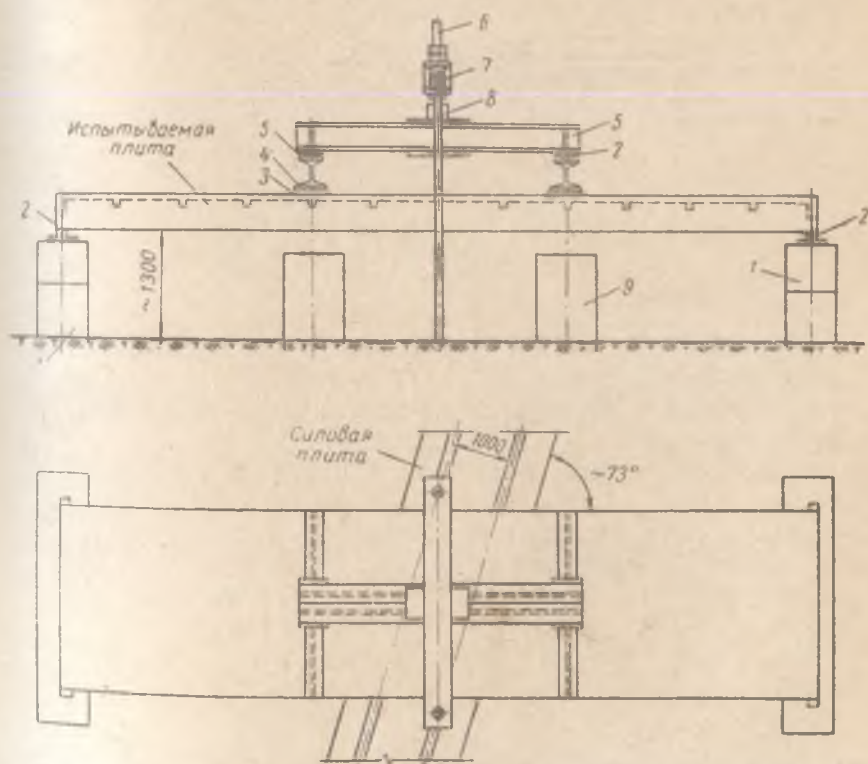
Схема испытания конструкции на силовой плите с выносом опорных подушек за пределы стенда:
